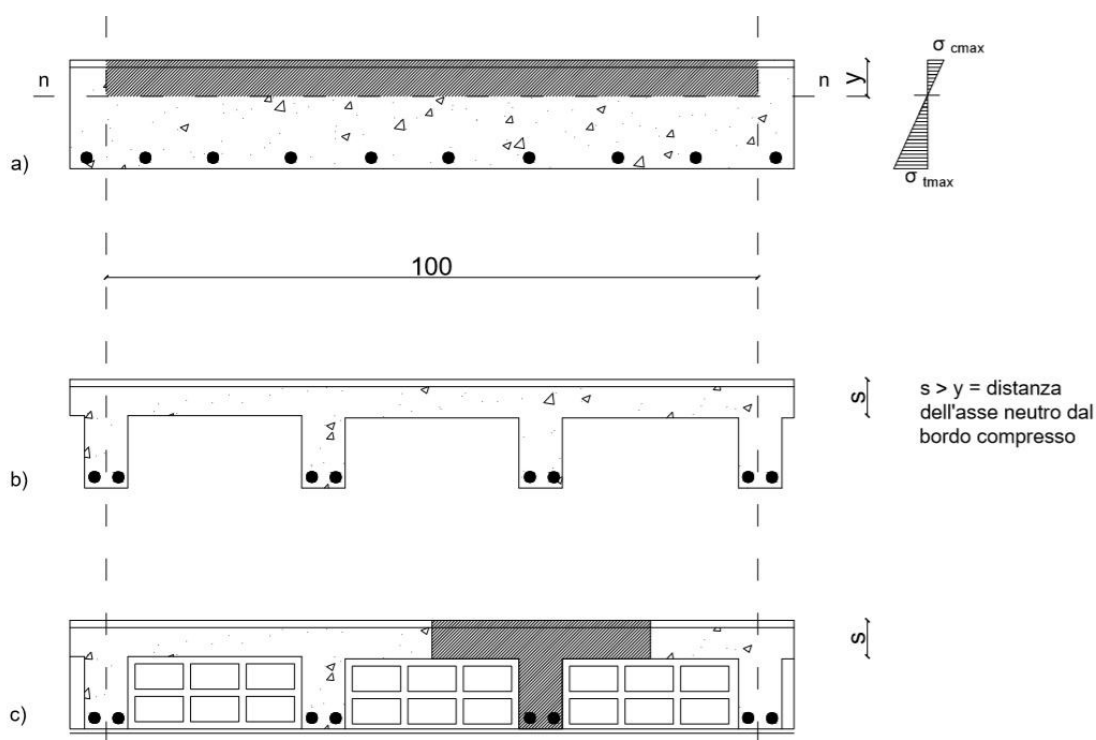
Sezione di un solaio (fonte: (8) - Caleca, Architettura tecnica)
